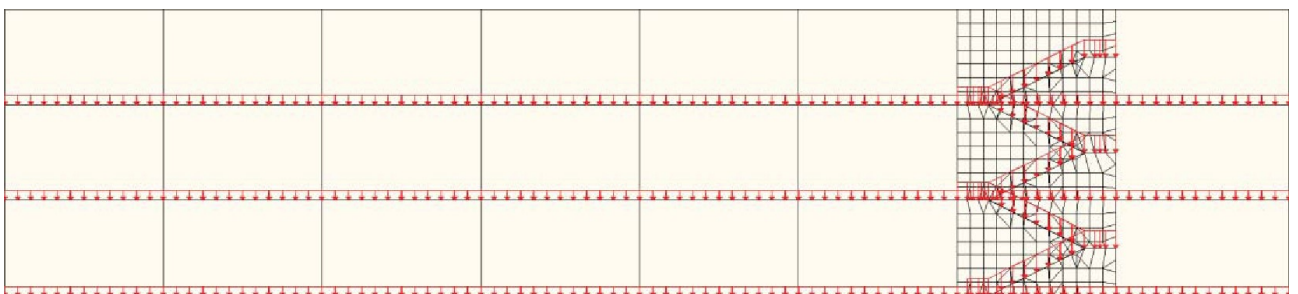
Схеми завантажень будівлі від корисного навантаження
